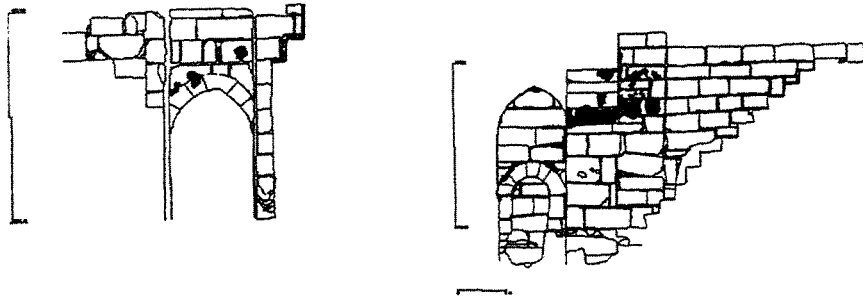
Alzados de los paramento bajo la estructura abovedada.
